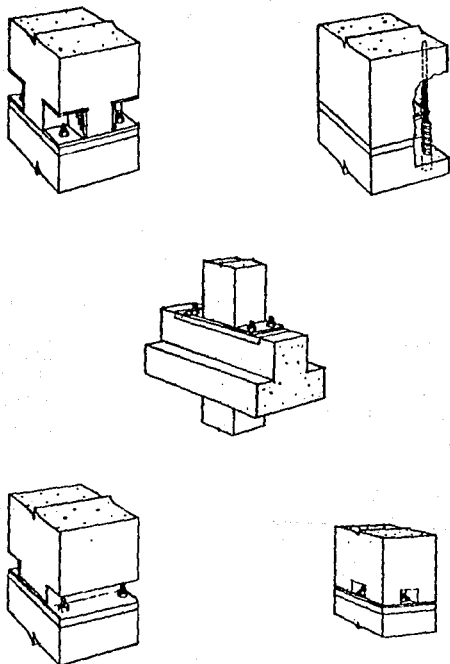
CONEXIONES COLUMNA A COLUMNA
